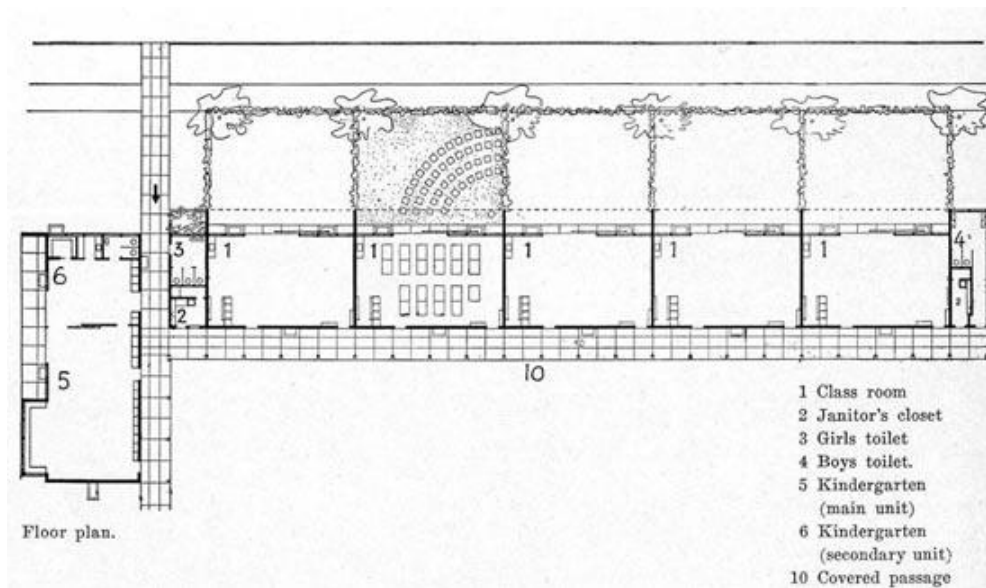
Planta baja del Corona School (1935) de Richard Neurta en Los Angeles. (Hidden Architecture 2021)
